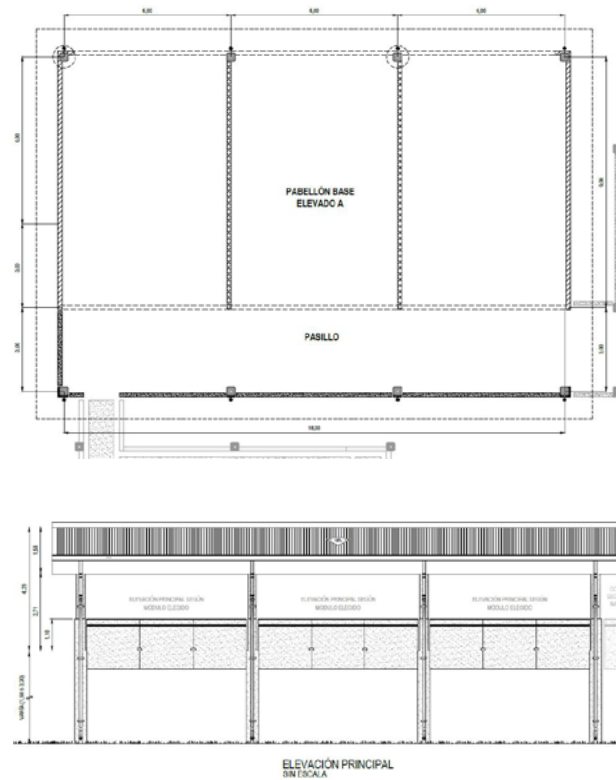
Pabellón Elevado Prototipo A - 216m². Fuente: DIEE (2018).
